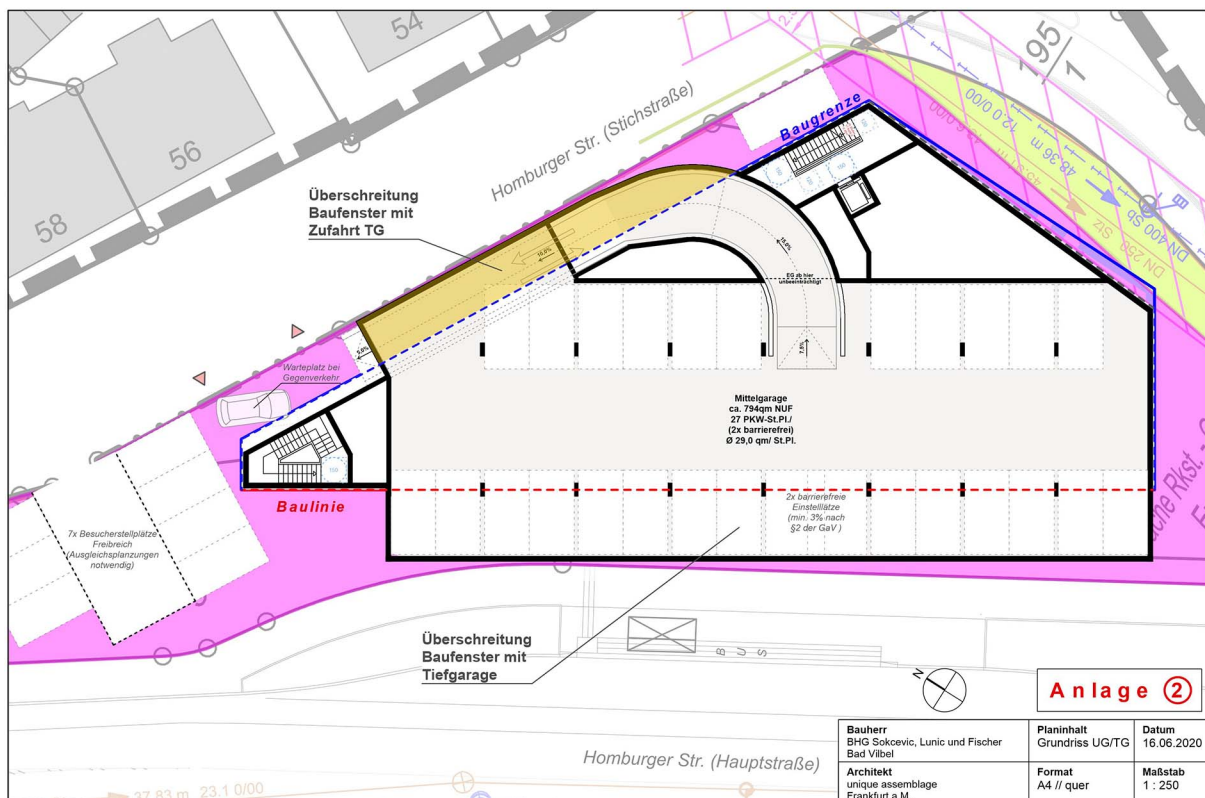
Neubau Geschäftsgebäude Homburger Straße - Bad Vilbel – Grundriss Tiefgarage
